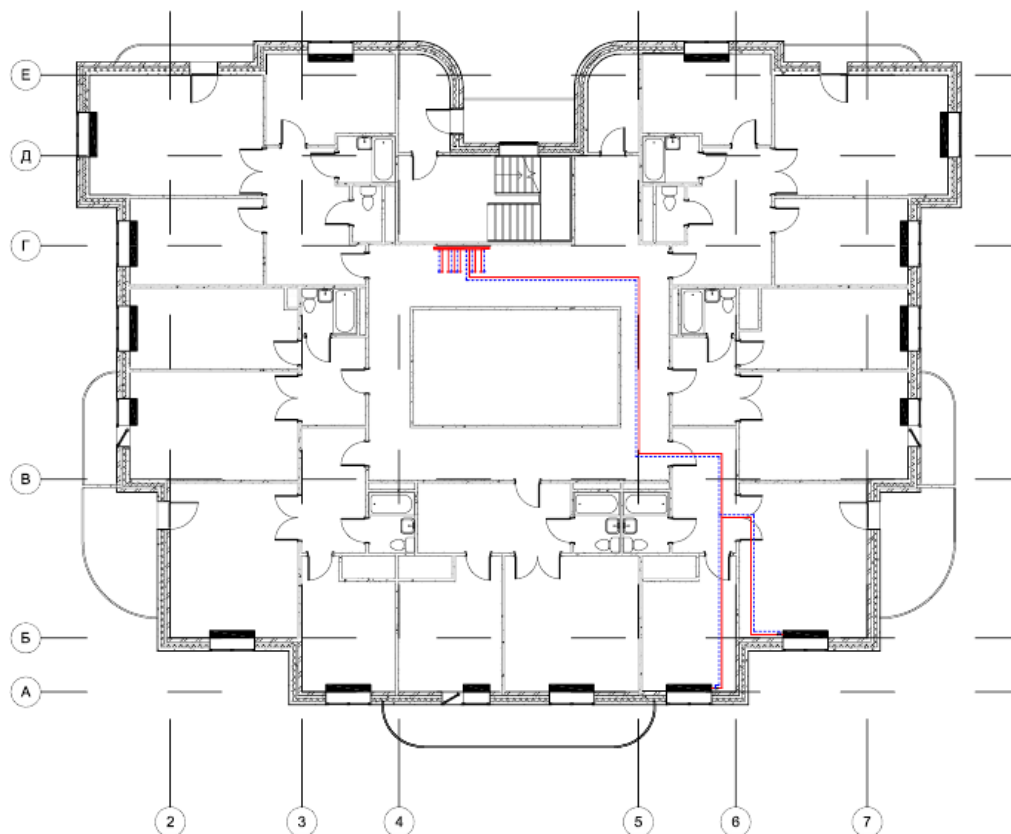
План последнего этажа с разводкой на наиболее загруженную квартиру
